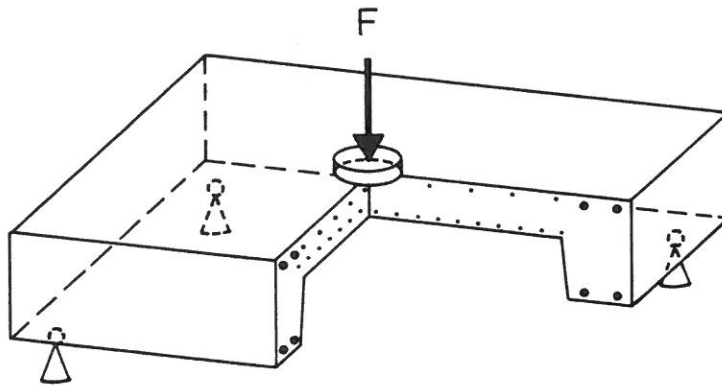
Stahlbetonplatte mit Einspannung in Randbalken und mittig angreifender Belastung (Schnitt-Darstellung)
